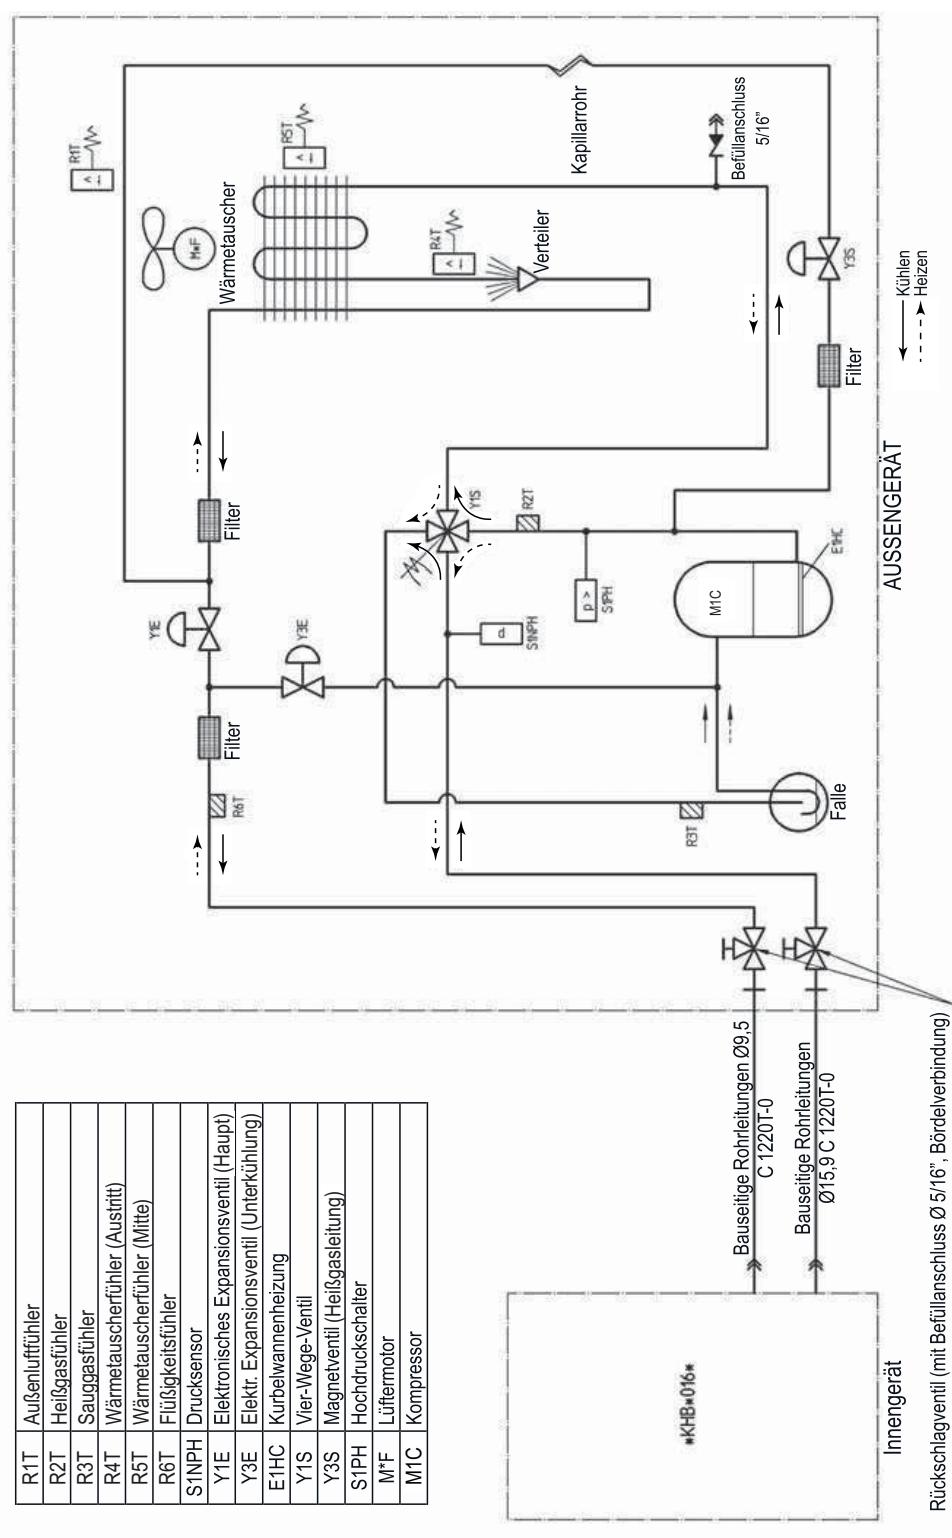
Kältetechnischer Aufbau - Außengerät RRLQ0(11/14/16)
